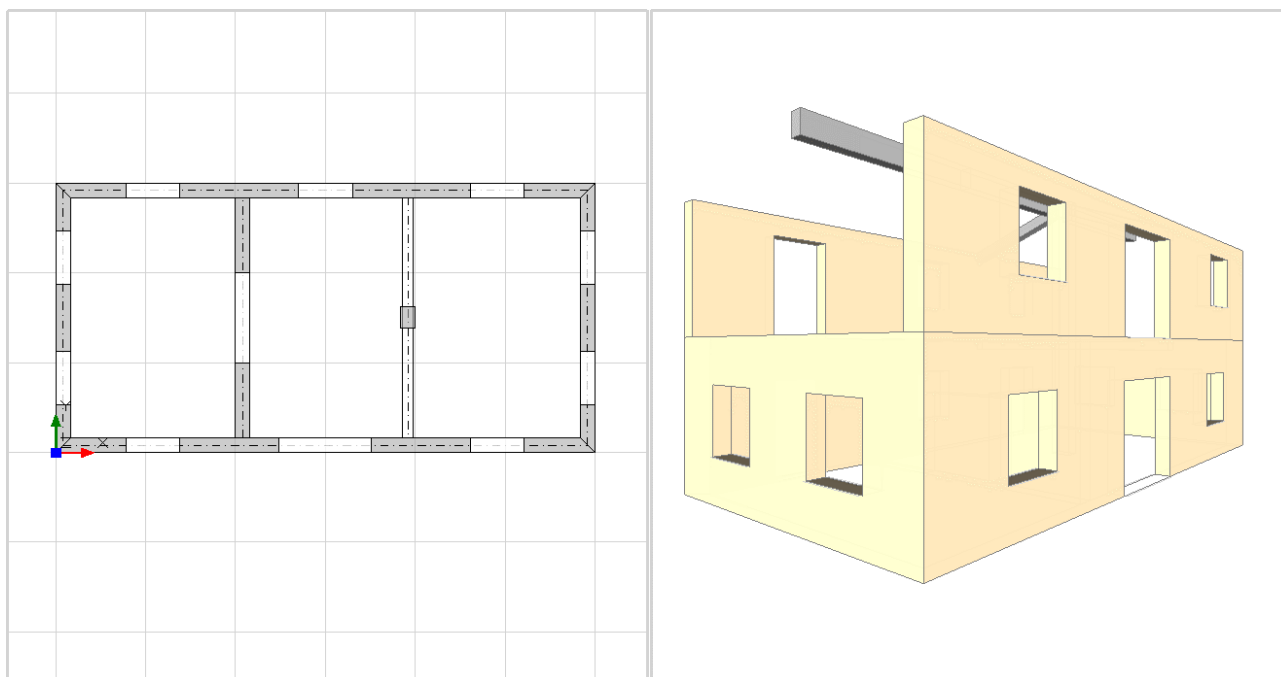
Pianta Piano Primo e vista 3D del modello in Aedes.PCM
